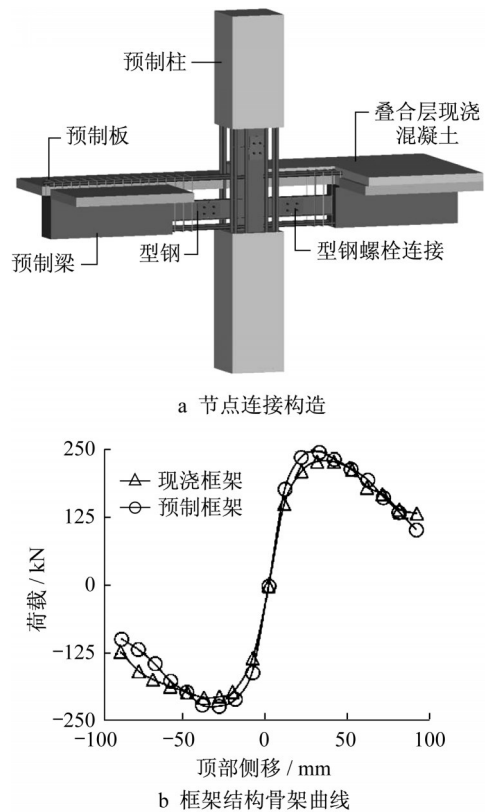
典型预制型钢混凝土框架节点连接构造与框架结构骨架曲线
